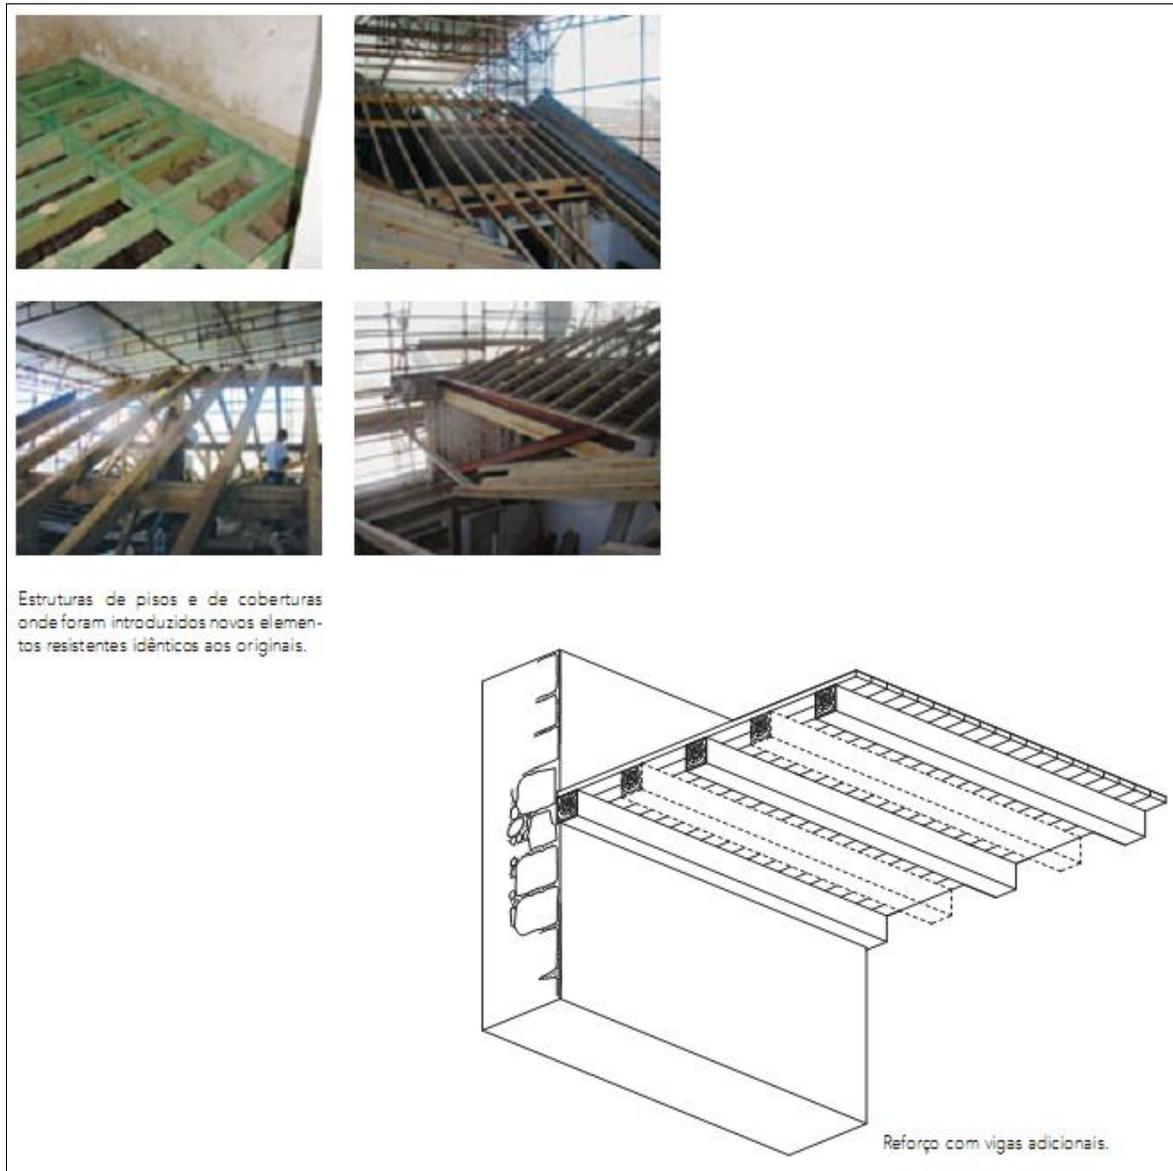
Adição de novos elementos a pisos e estruturas de coberturas de madeira, utilizando o mesmo material. Reconstituição da secção usando o mesmo material com ou sem elementos de ligação
